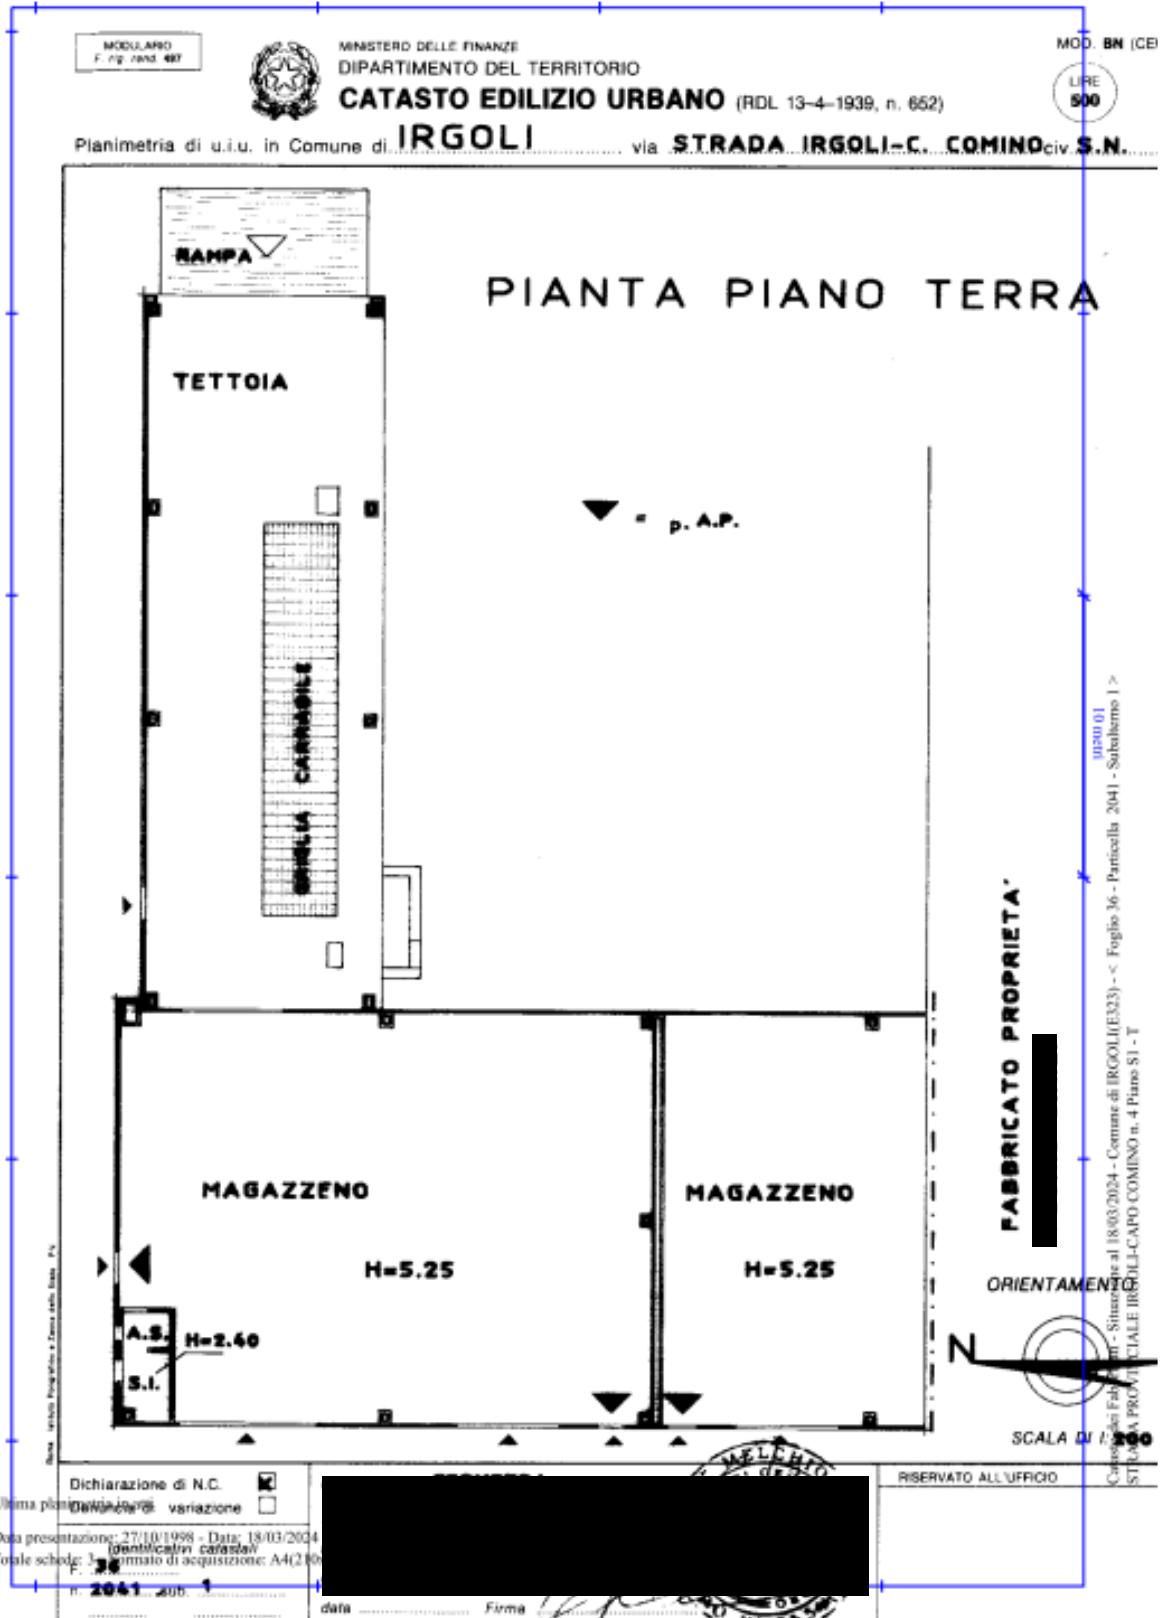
\_planimetria catastale del f.36 p.la 2041 sub1/parte (stabilimento + magazzino)
